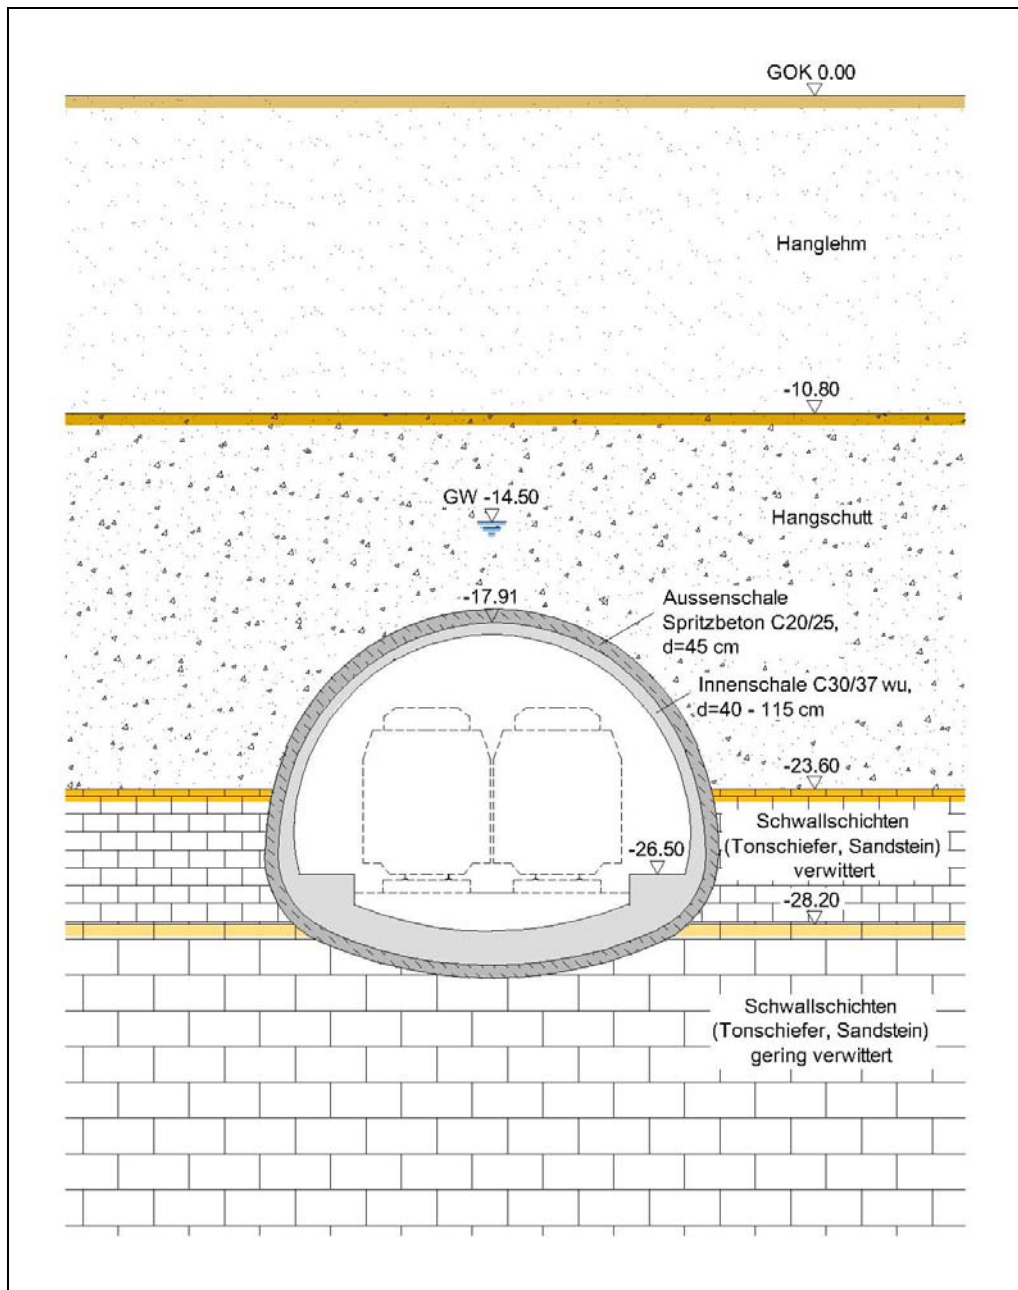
Tunnel in Spritzbetonbauweise, Querschnitt
